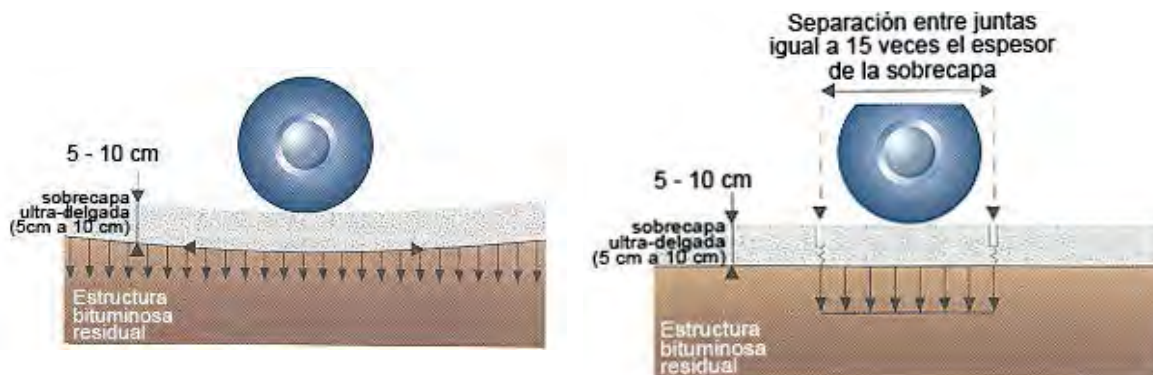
Por falta de juntas de retracción cercanas, hay riesgo de fisuración anárquica del concreto y riesgo de aparición de escamas en la cara vista de la sobrecapa por el efecto de gradientes térmicos
